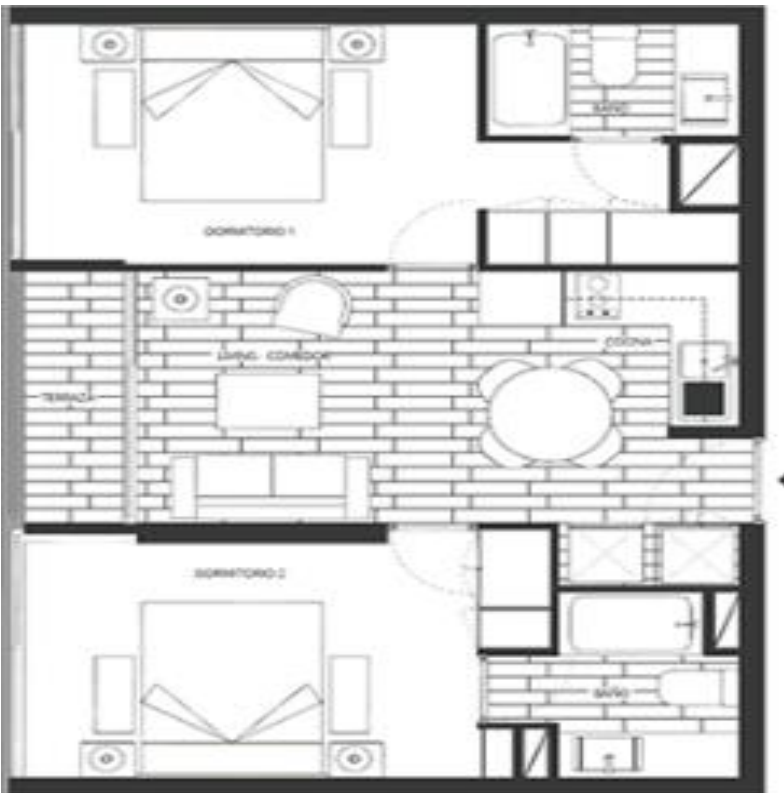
Planta departamento Tipo 4, proyecto Edificio Central (Fuente: <http://www.ilossilos.cl>)
